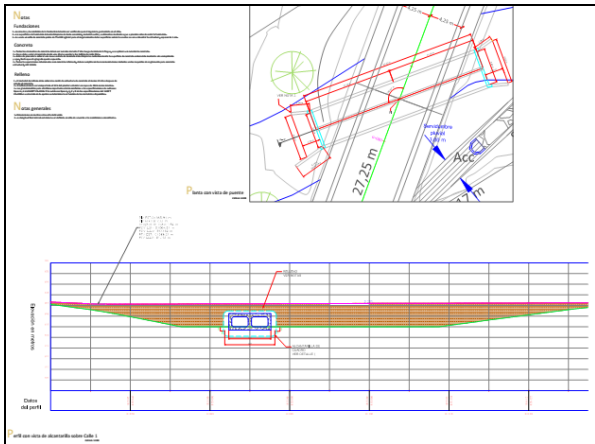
Detalle de perfil y planta de alcantarilla sobre Quebrada sin nombre Sur (Ver Apéndice, Lámina 16, 17 y 18).
